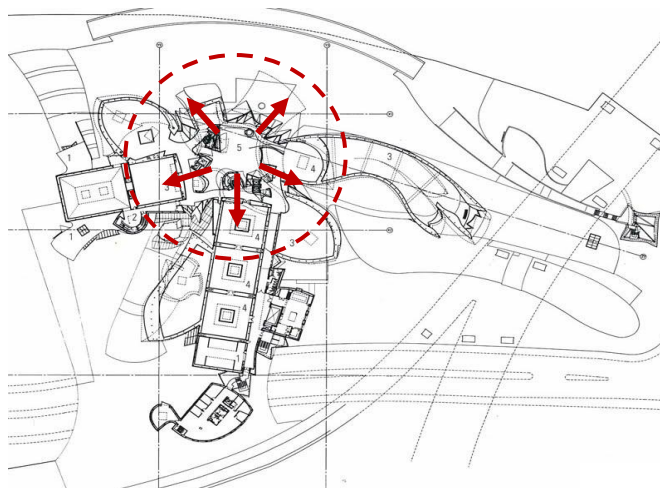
planta baixa do Museu Guggenheim de Bilbao.
